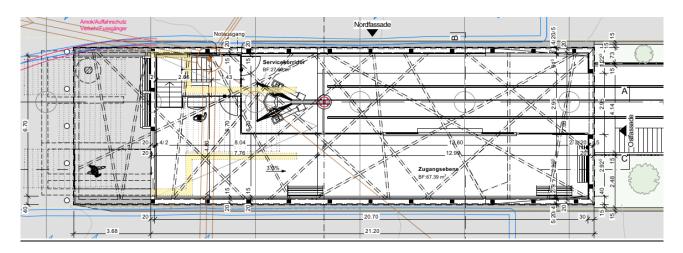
Grundriss geplante Talstation mit ebenerdigem Ein-/Ausstieg
